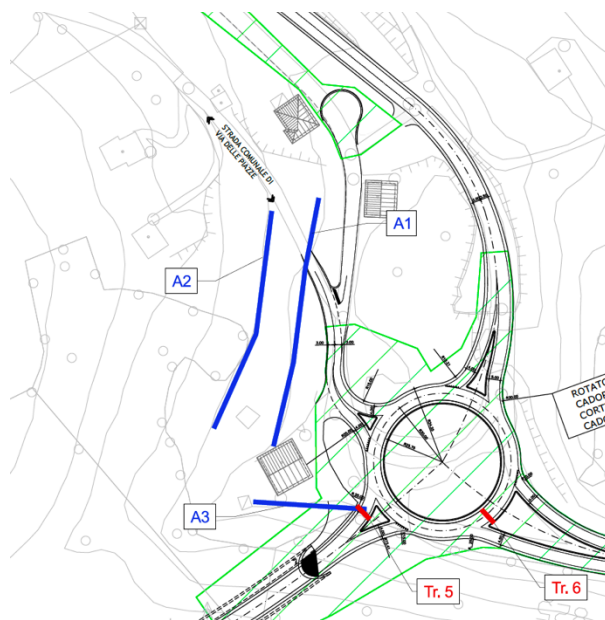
Stralcio planimetria ubicazione indagini: dettaglio Svincolo Tai Est
